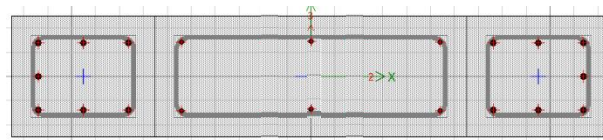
46 MURO DE CORTE INICIAL
